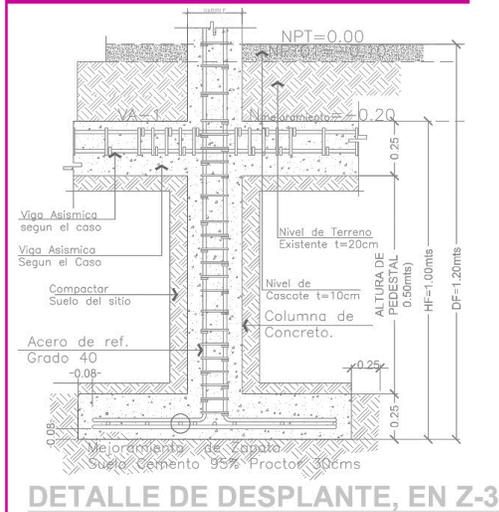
Detalles Constructivos. Diseño estructural Fuente: J S V Consultores.
